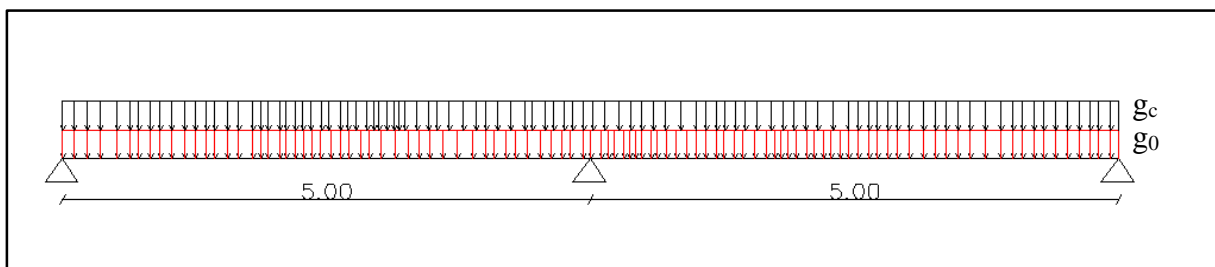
8 : Schéma statique de la poutre de chaînage.
